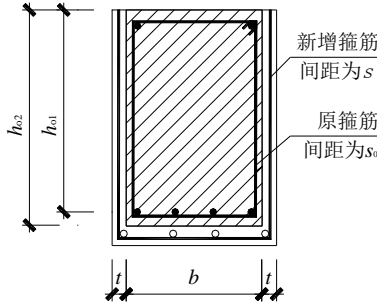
高延性混凝土三面围套加固钢筋混凝土受弯构件示意图
